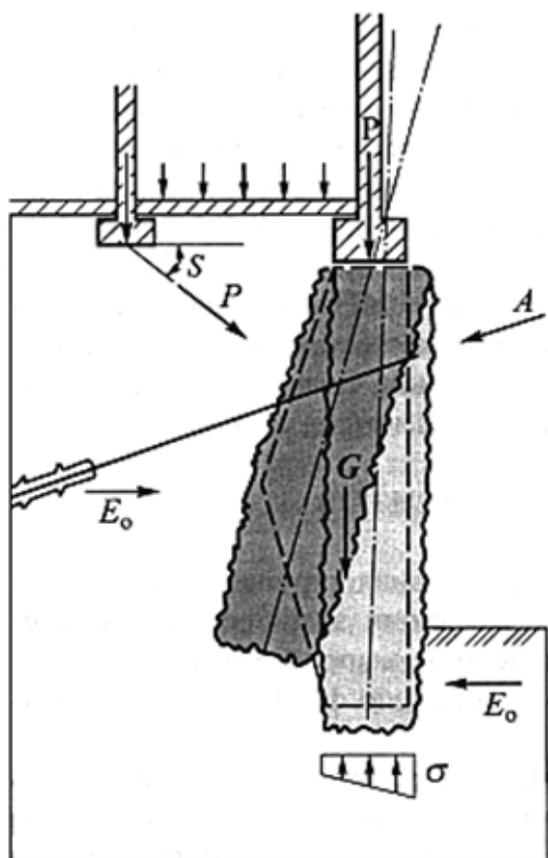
Расчетная схема грунтоцементных свай и грунтобетонной подпорной стенки, служащих ограждением котлована возводимого здания и усилением основания
